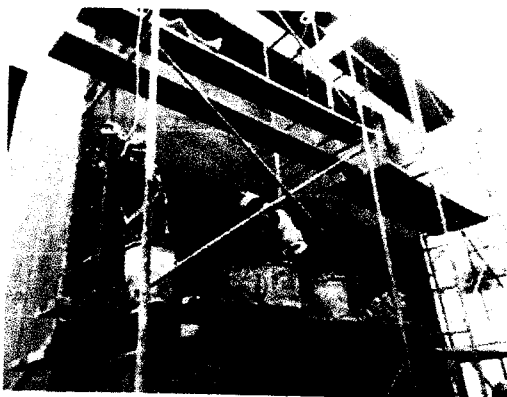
Y 06: Tarrajeo en muros, vigas y columnas exteriores. EXTERIOR ZONA DE SERVICIOS.
